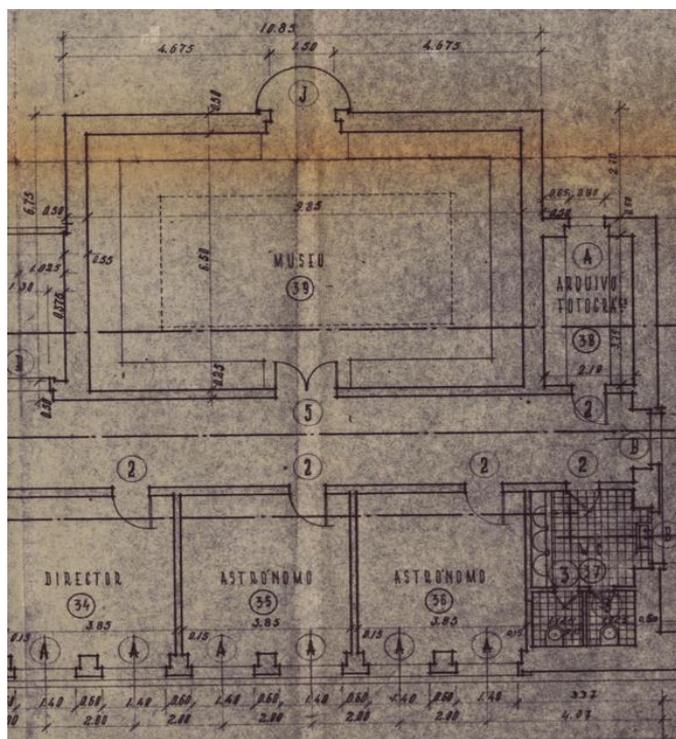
Planta do Edifício Central – pormenor da sala do Museu.
